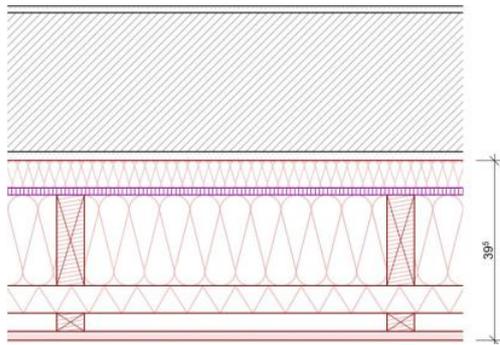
Fischbach Fassade Holzfaser-Einblasdämmung
